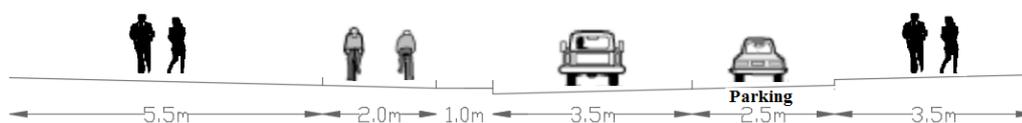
Perfil Transversal da Rua Luís Reis dos Santos com passeio de 5,5 m junto ao DEM
